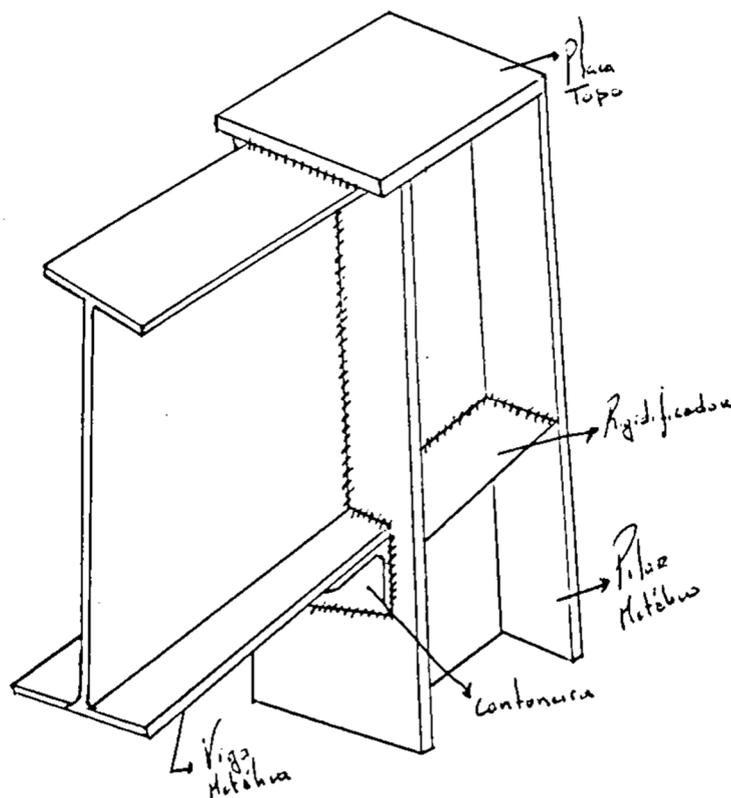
Ligação pilar e viga metálica (Fonte: Autor)
